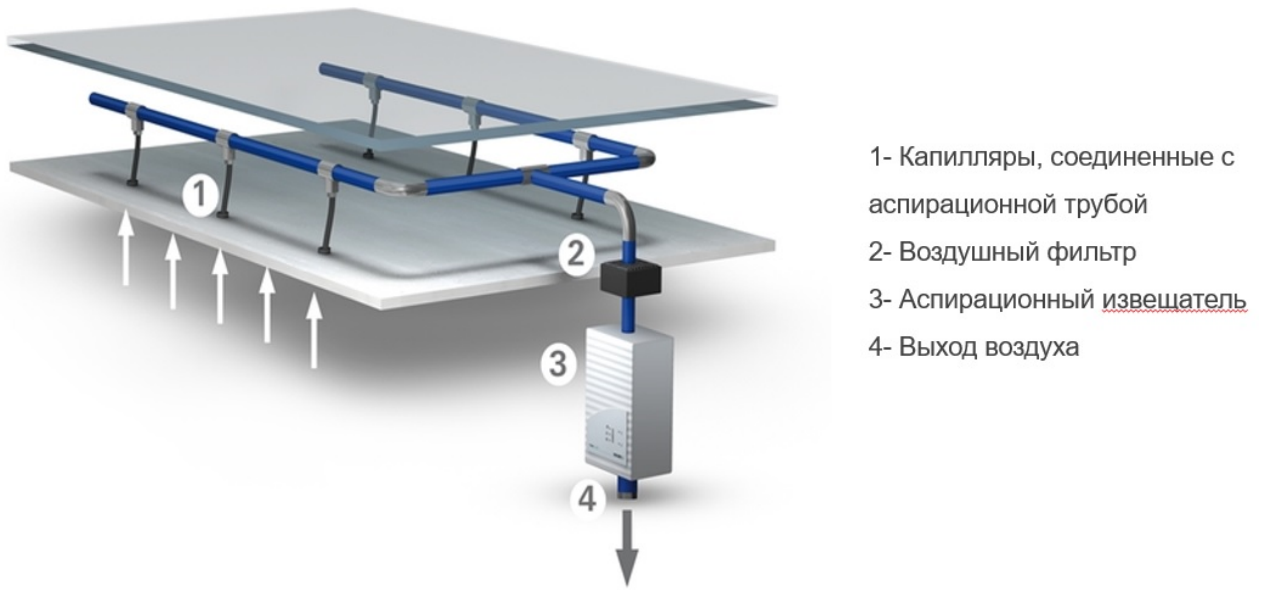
, Организация скрытого монтажа аспирационных труб
